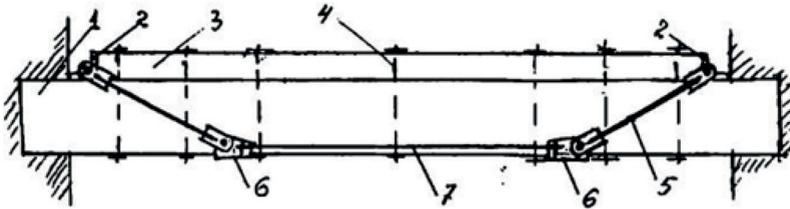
Метод, при котором деревянные балки укрепляются с помощью предварительно напряженных зажимов, а сверху на них укладываются балки или доски: 1 – усиливаемая балка; 2 – верхний упорный уголок; 3 – брус или доска наращивания; 4 – стяжные болты; 5 – наклонный тяг из круглого стержня; 6 – нижний упор затяжки; 7 – горизонтальный тяг из круглой стали
